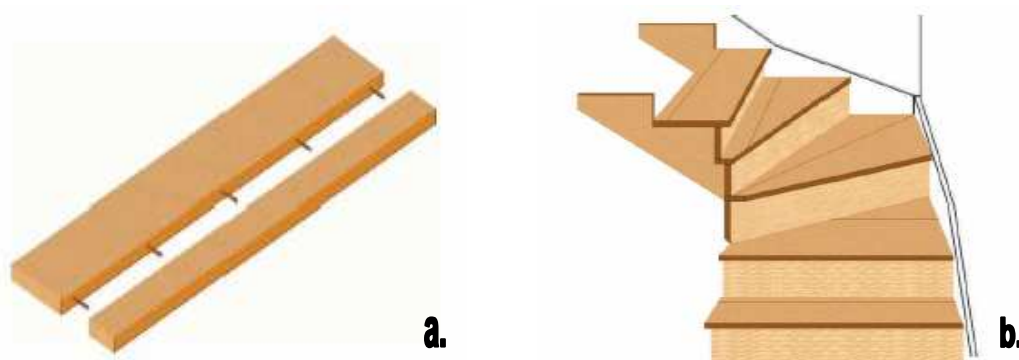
a. Encolado de piezas de madera para el armado de las huellas de una escalera b. Ejemplo de huellas encoladas de tipo recto y diagonal en zona de abanico
